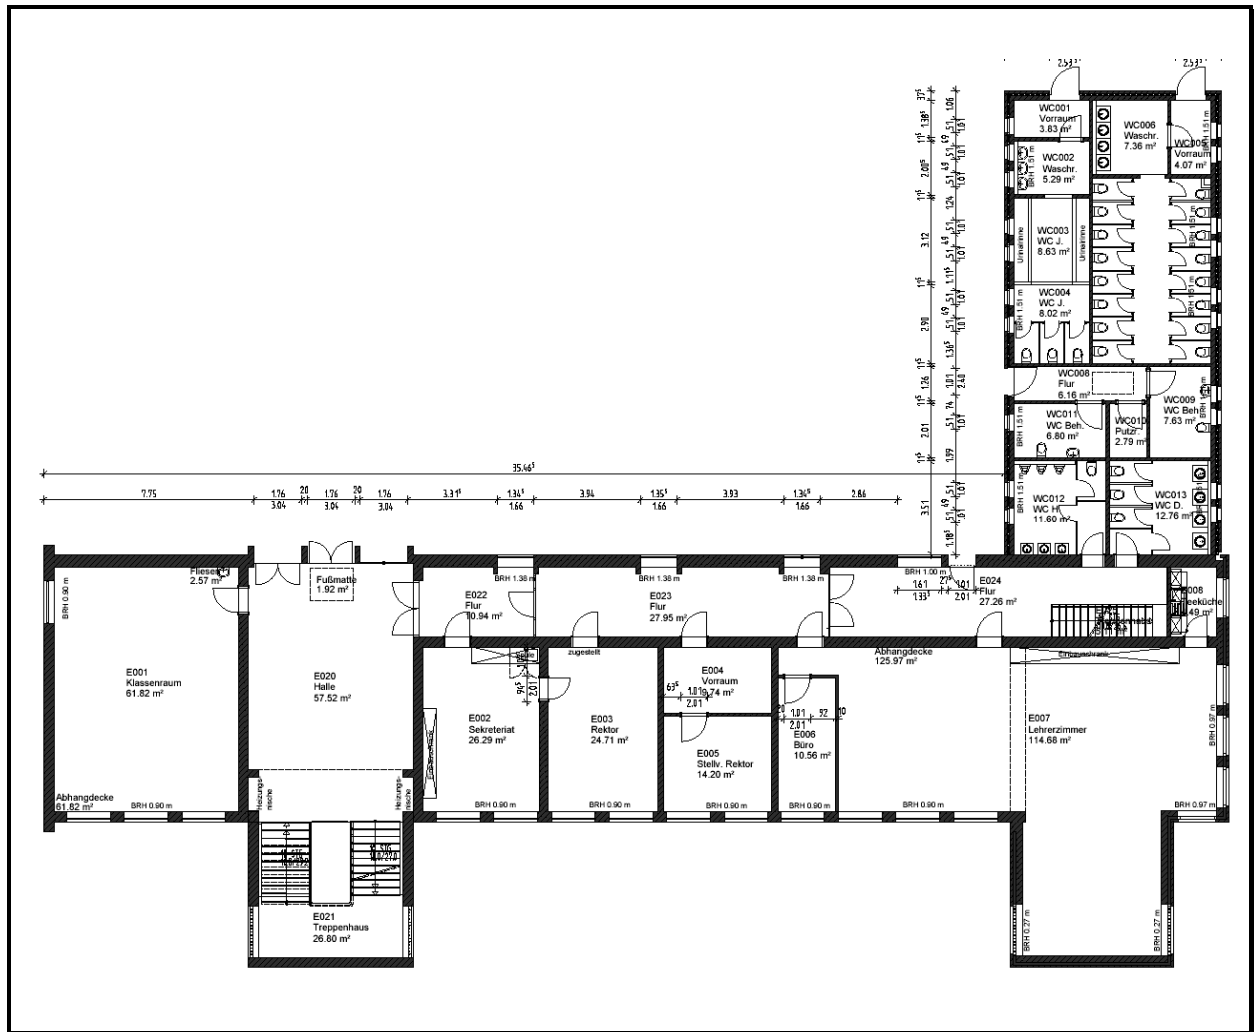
Friedrich-Ebert-Realschule: Grundriss Erdgeschoss Bauteil E mit angrenzender WC-Anlage
